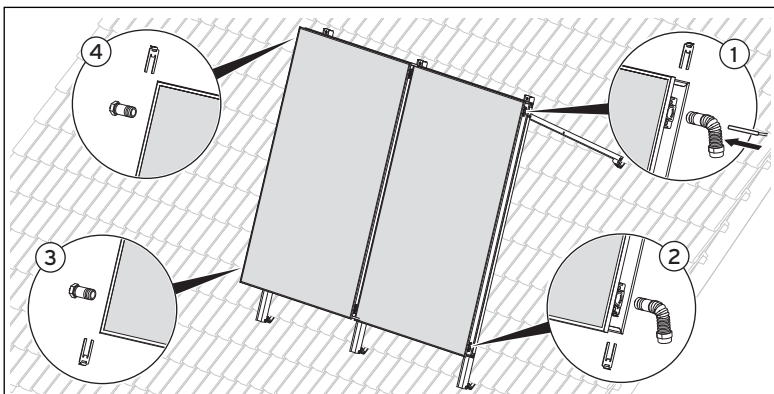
Montaggio dei collegamenti idraulici su un solo lato
